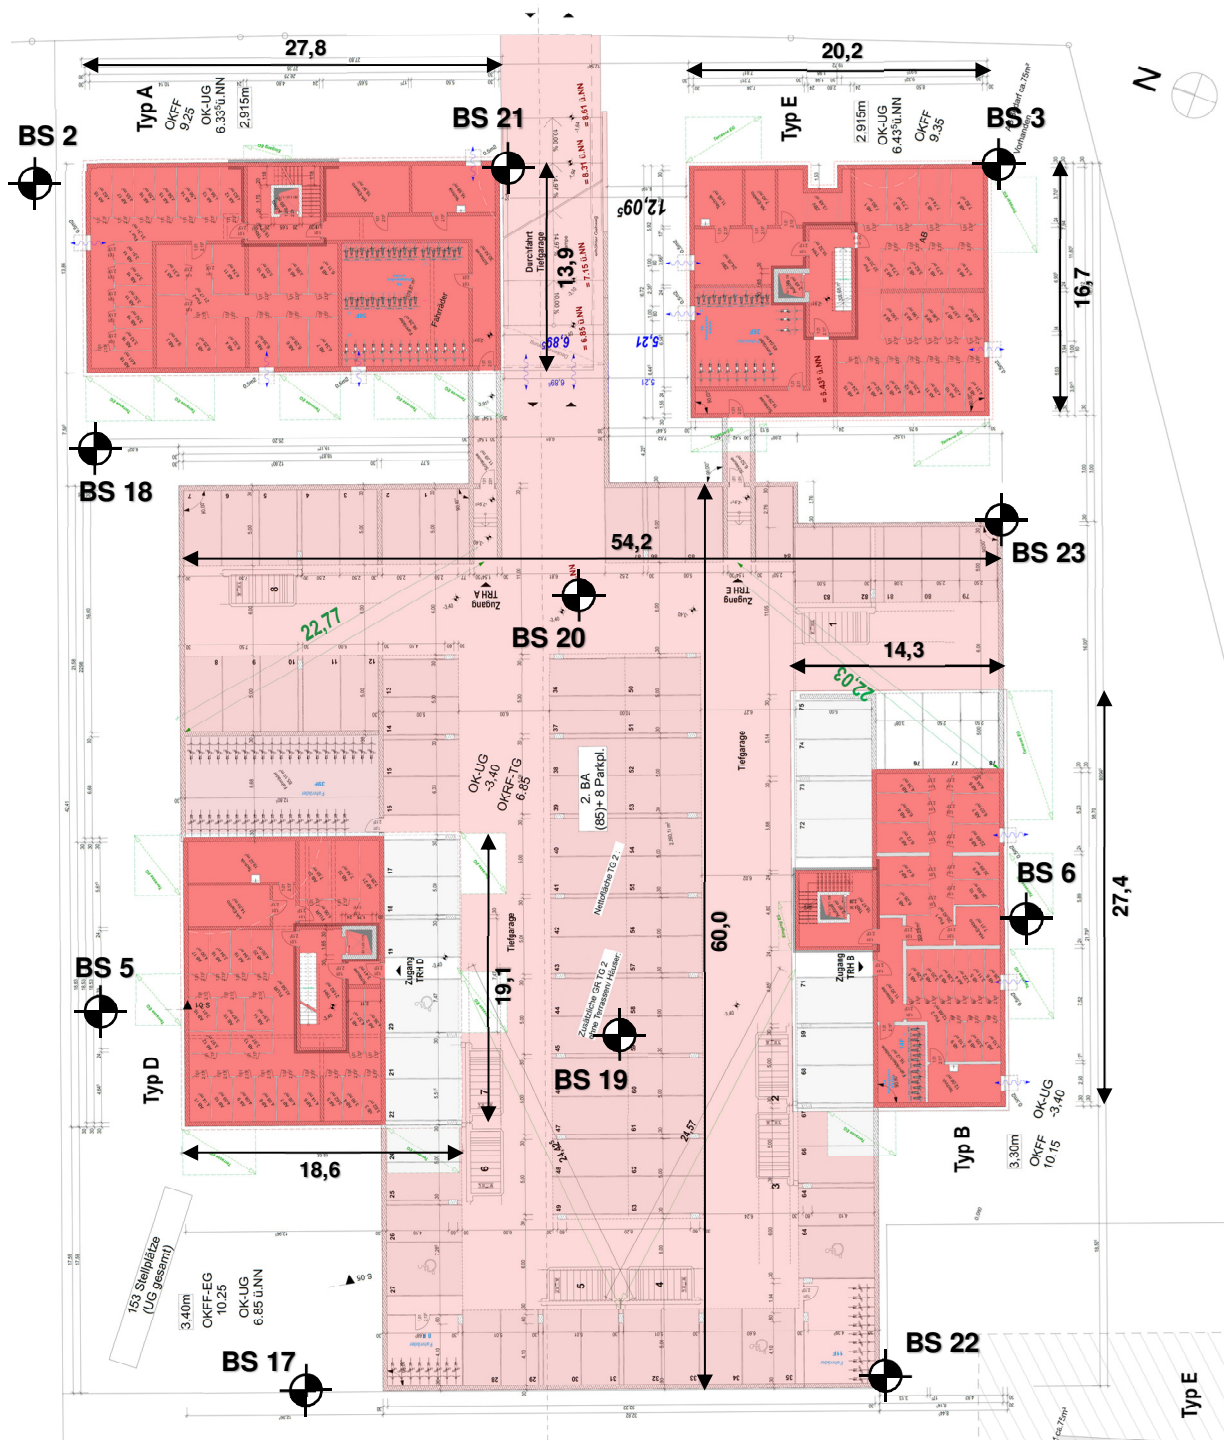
Grundriss TG/KG im 2. BA, M 1:500
